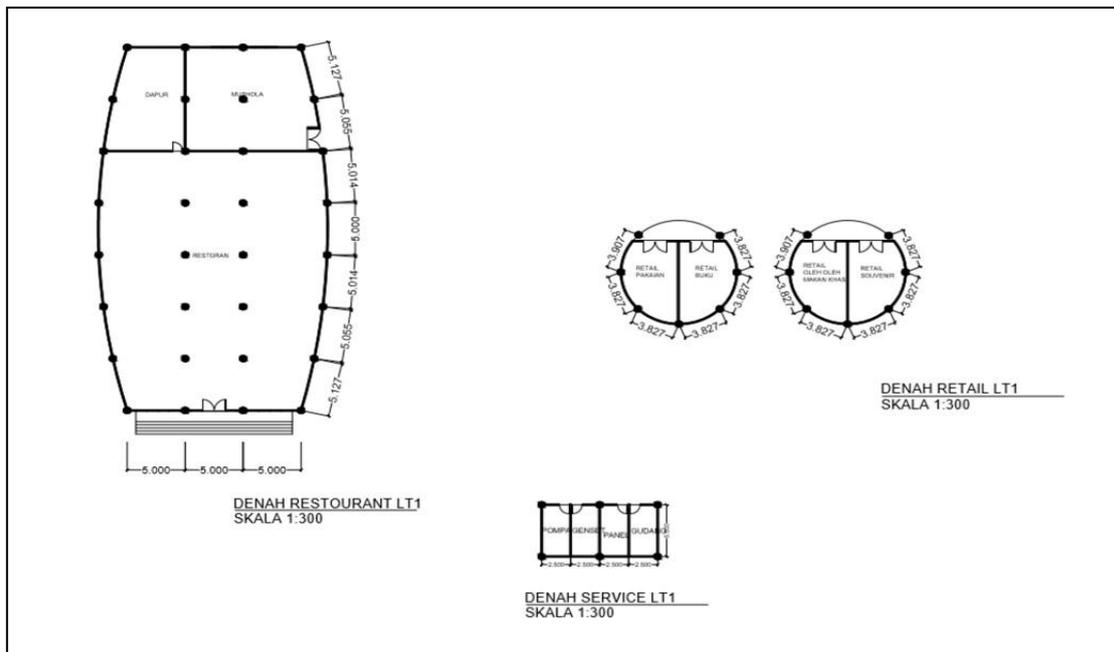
Site plan Pusat Budaya Kota Pontianak
